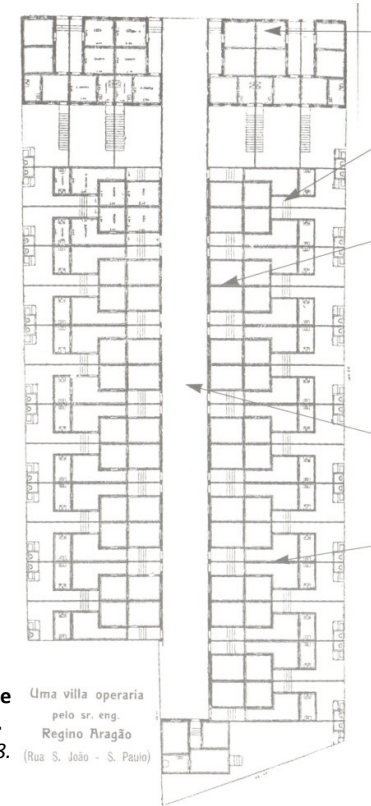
Ejemplo de planta de villa operaria construida en 1911.
